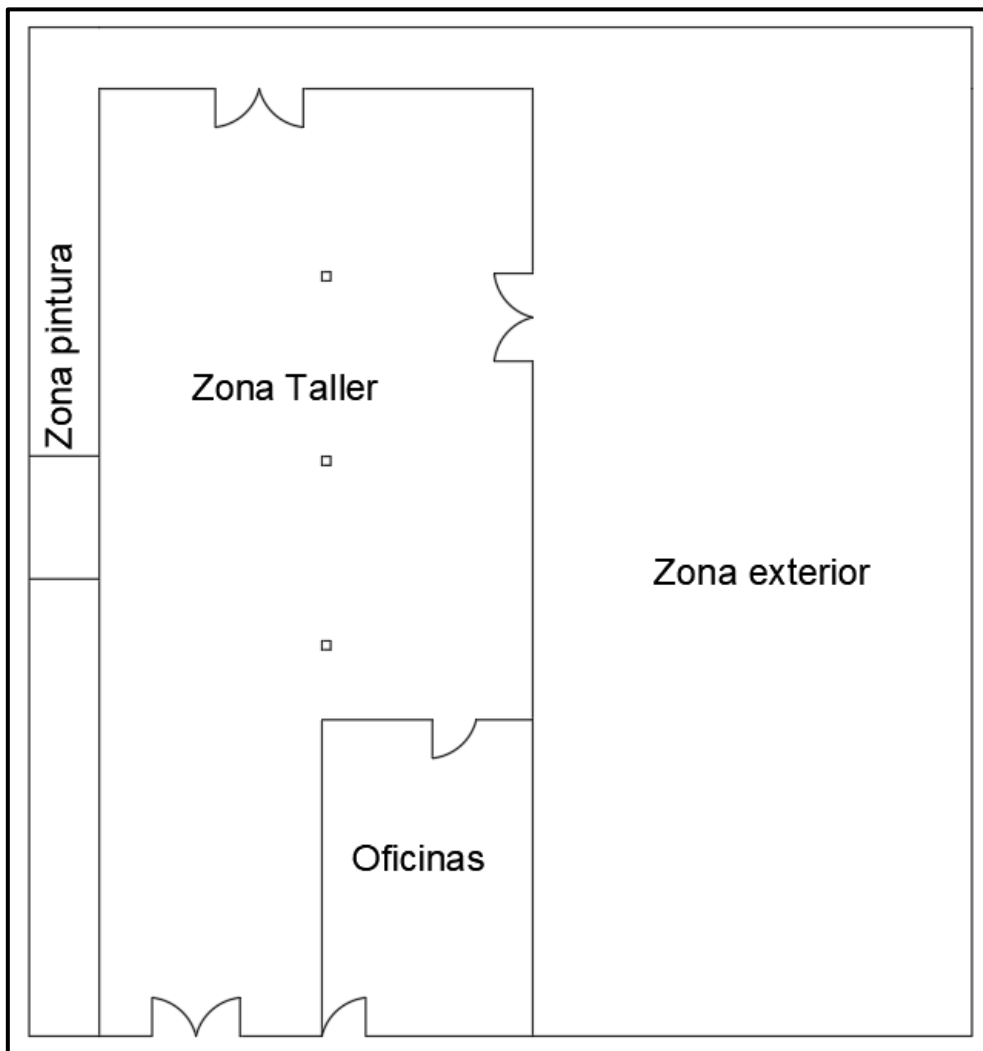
Plano Talleres Quintana S.L. Fuente: Trabajo de campo.
